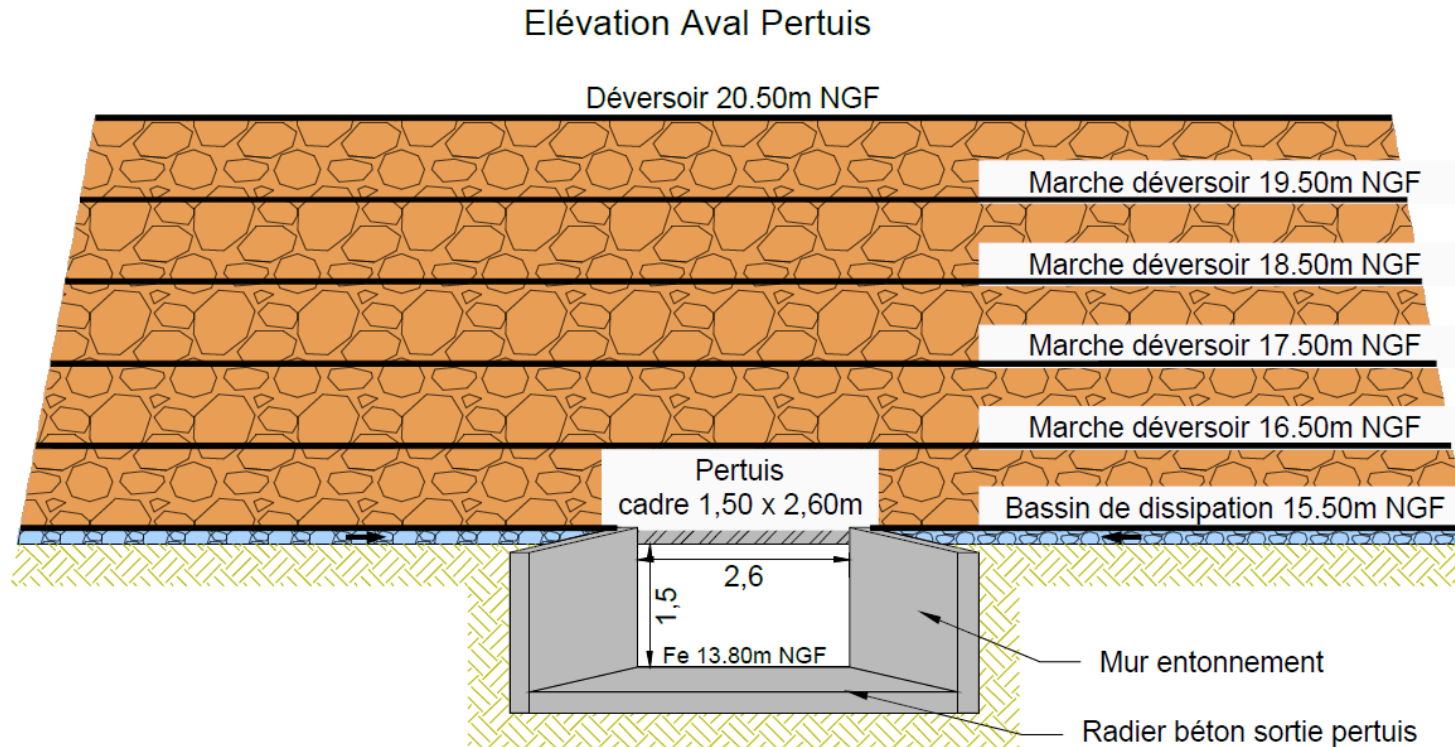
Profil en travers au droit du pertuis de fond, face aval – plan AVP
